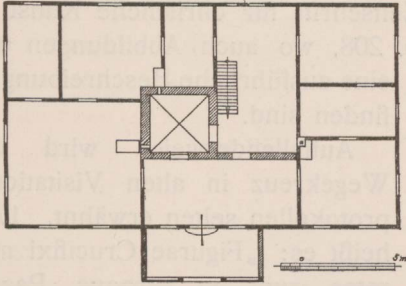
Grundriß des Mürauschen Hauses in Gnojau. Maßstab 1:400.
